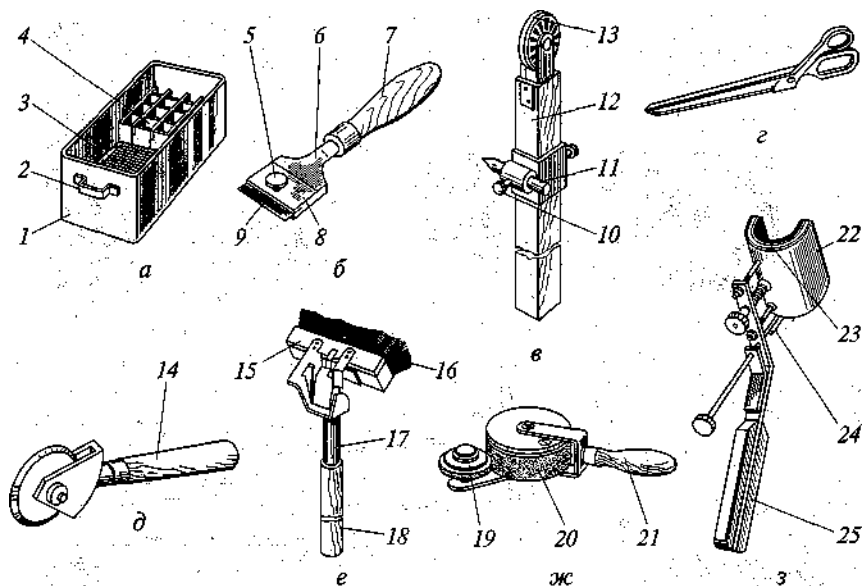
Ручной малярный инструмент для подготовки оснований:
